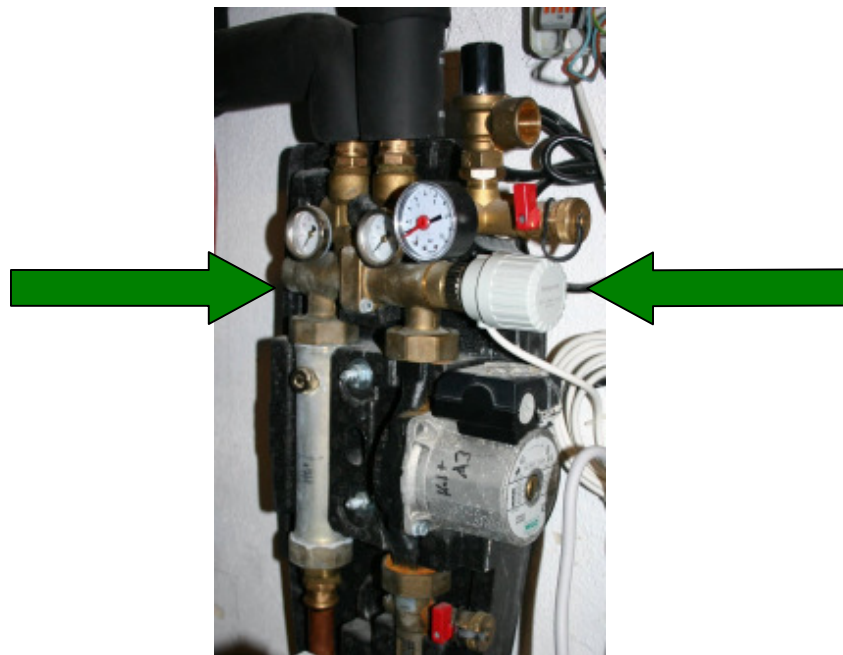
Solarpumpengruppe mit dem beidseitigen Absperrventil mit dem weißen elektrischem Stellmotor (Foto bei geöffneter Dämmabdeckung).
